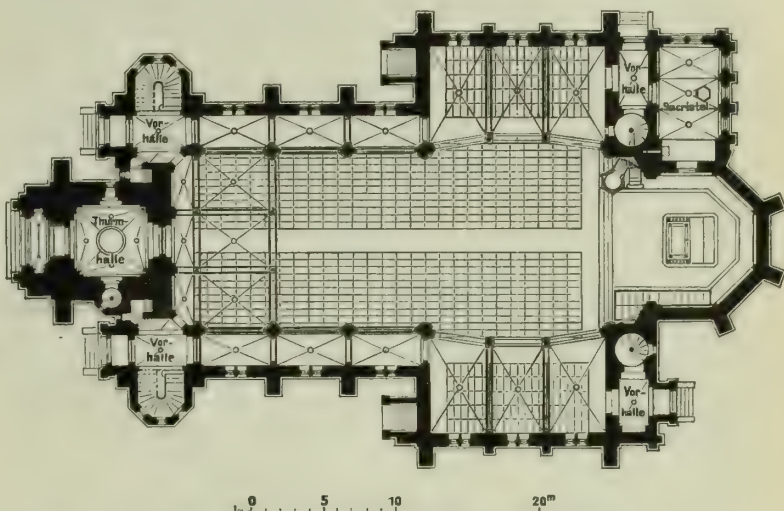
Grundriss des unteren Kirchenraumes.
